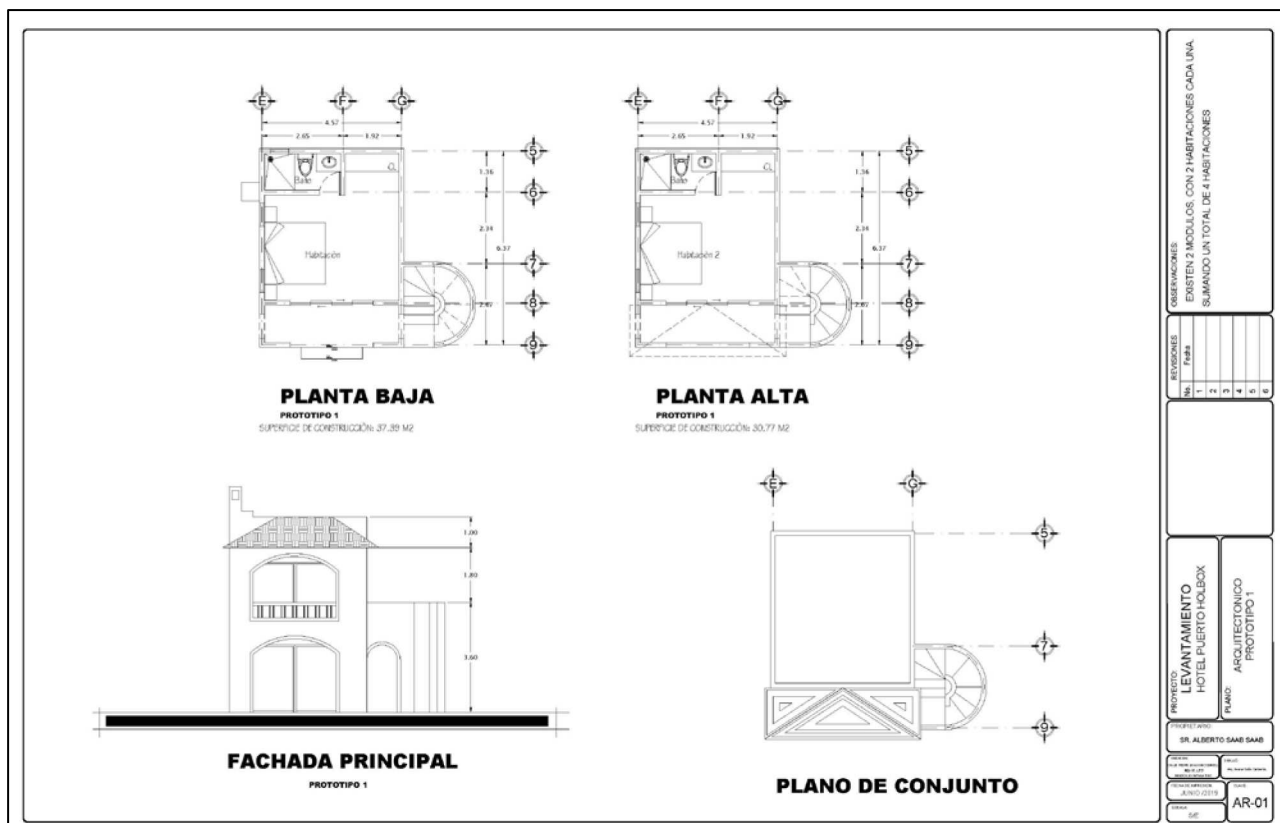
Plano planta baja, planta alta, fachada y plano de conjunto de las construcciones número 3 y 4
